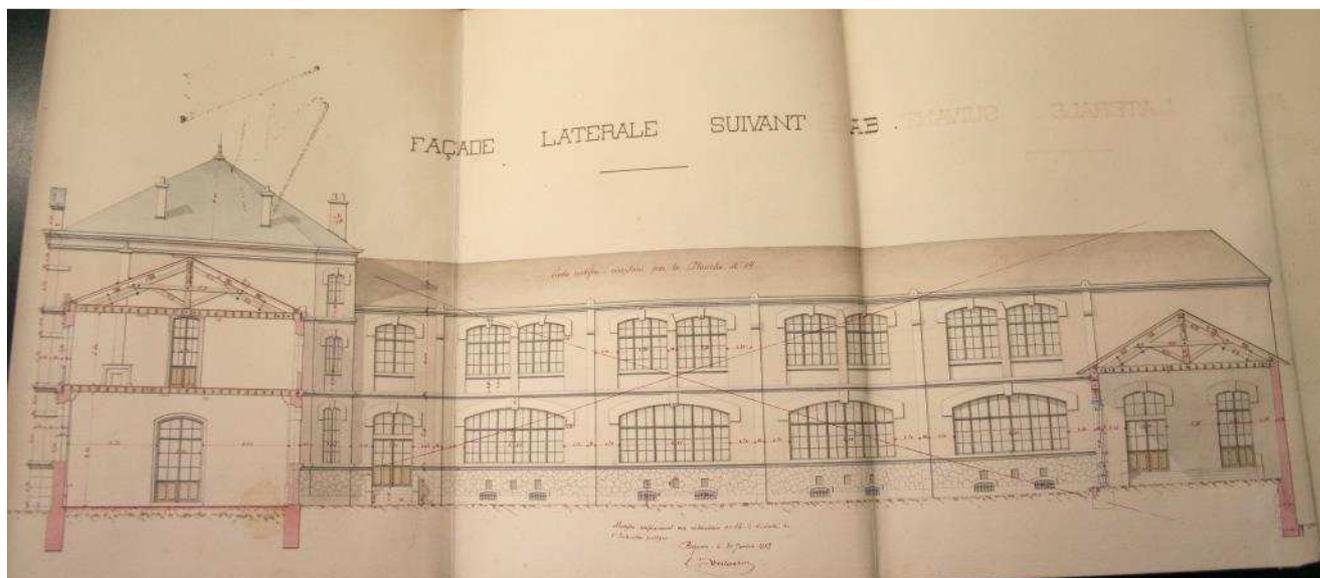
Projet de Groupe scolaire. Façade latérale suivant AB.
